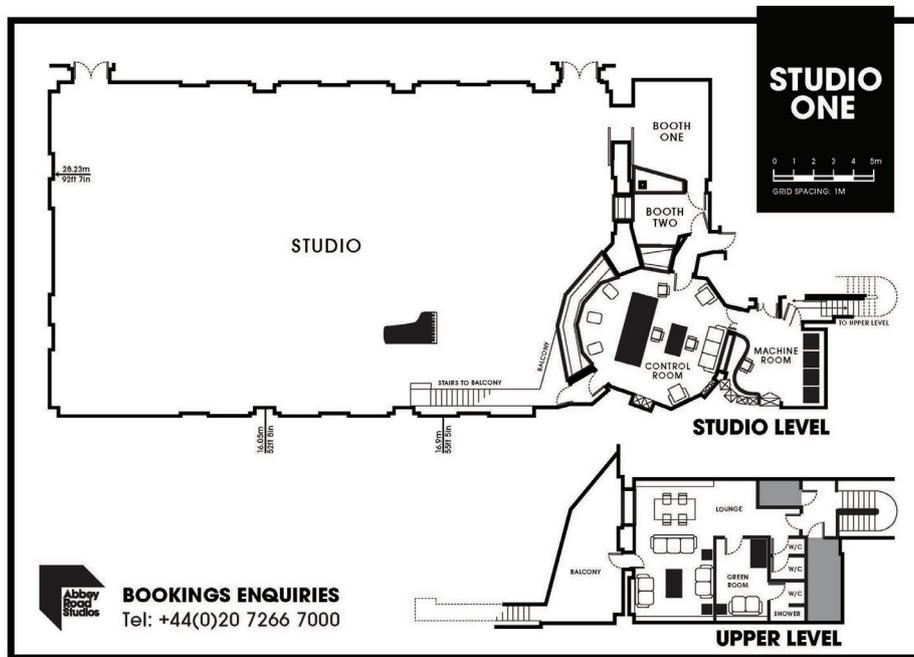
Planta Studio One. Abbey Road (EMI). 2019
